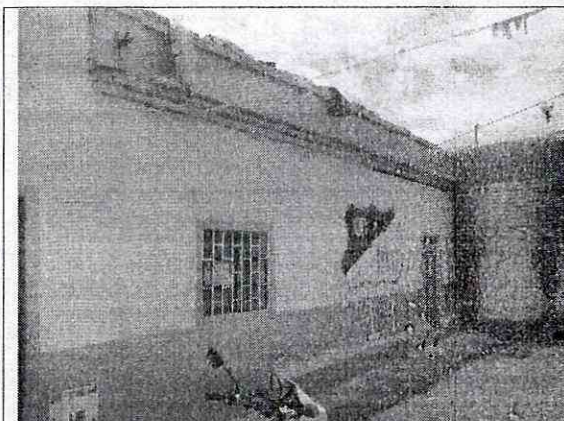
Detalle de la fachada del predio donde se presenta el colapso estructural.
